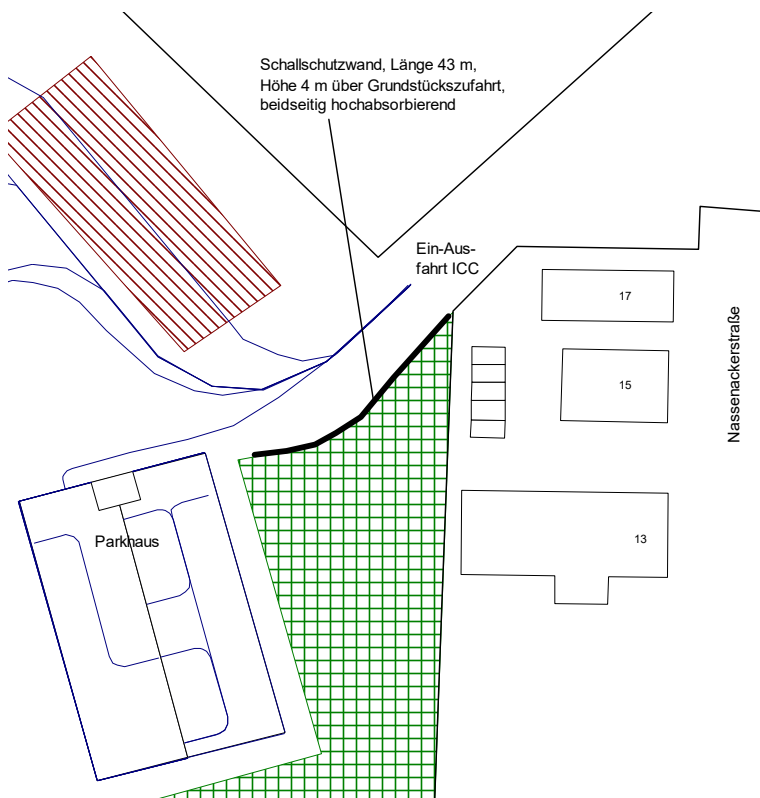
Grundriss Schallschutzwand im Ein-/Ausfahrtbereich zum ICC
